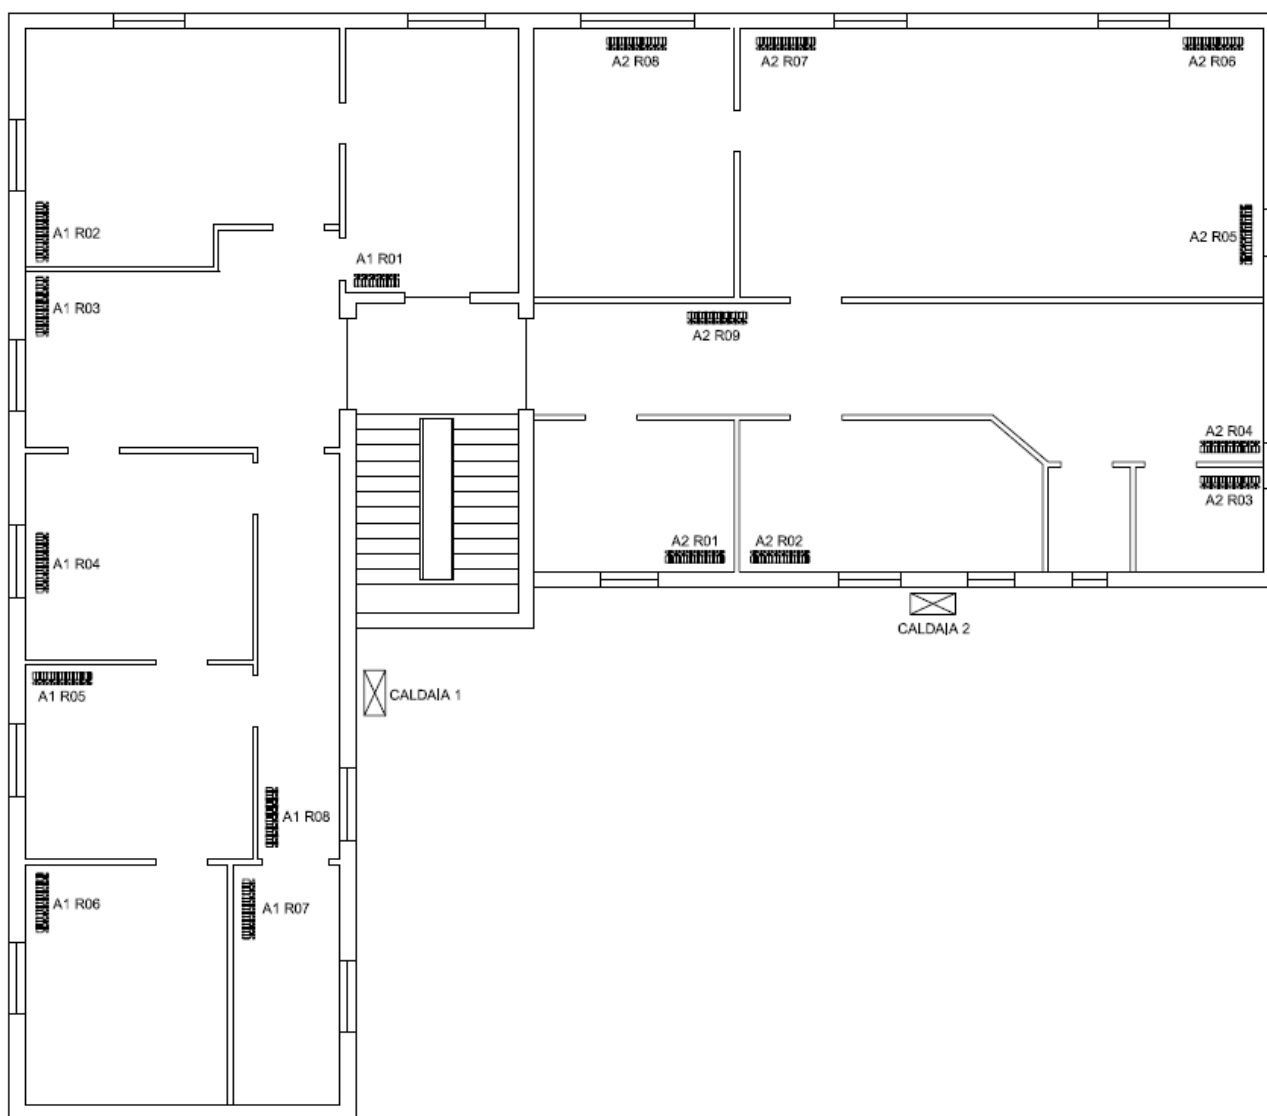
Planimetria Piano Primo (AP_1 e AP_2)
